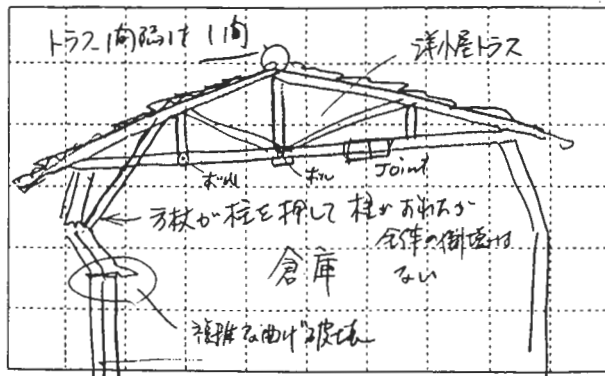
No.3 トラスによる倉庫(西宮市浜町、松竹梅酒造)。30年以上前に建築、1間間隔洋風トラス。外部にあった鉄柱によって倒壊は免れている。妻壁に鉄筋ブレース補強。軒は腐朽・蟻害が顕著。
